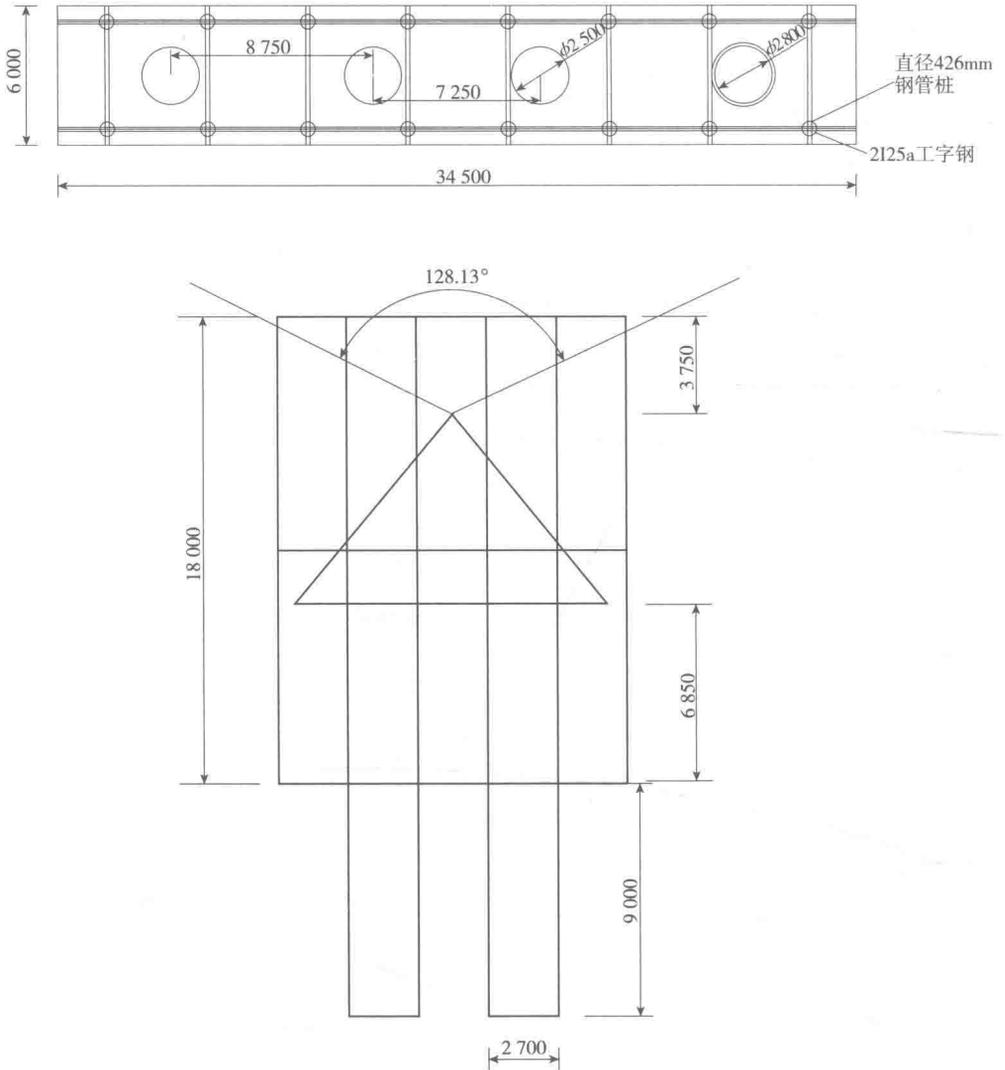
水上桩基钻孔平台体系平面图(尺寸单位:mm)
